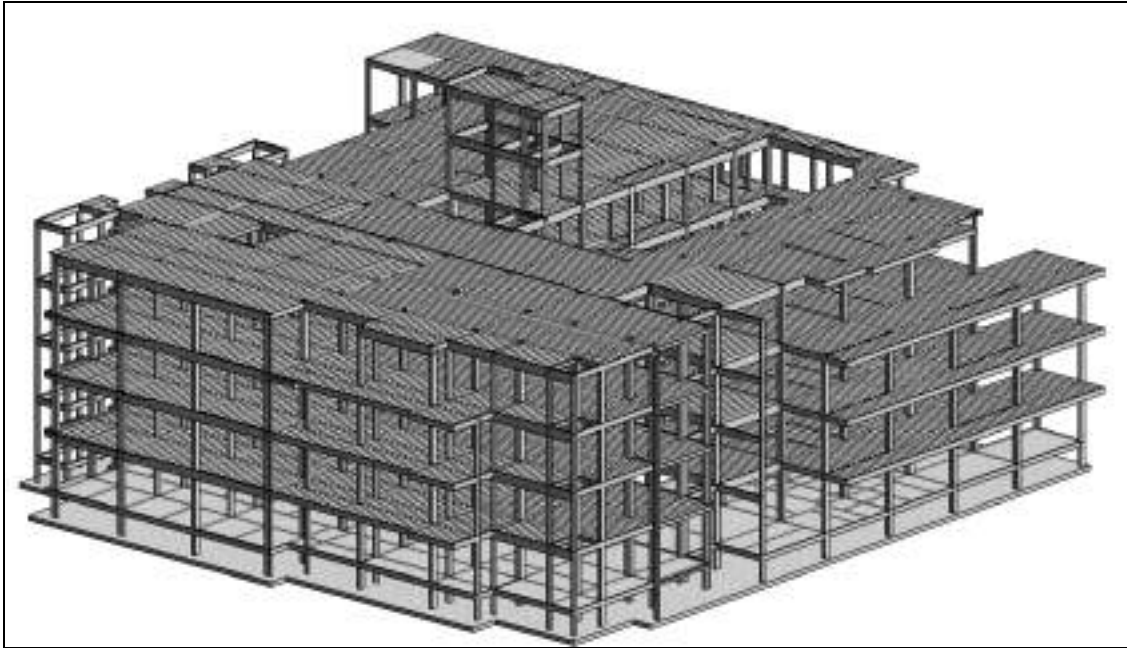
Autodesk Revit - Modelado de estructuras del edificio completo
